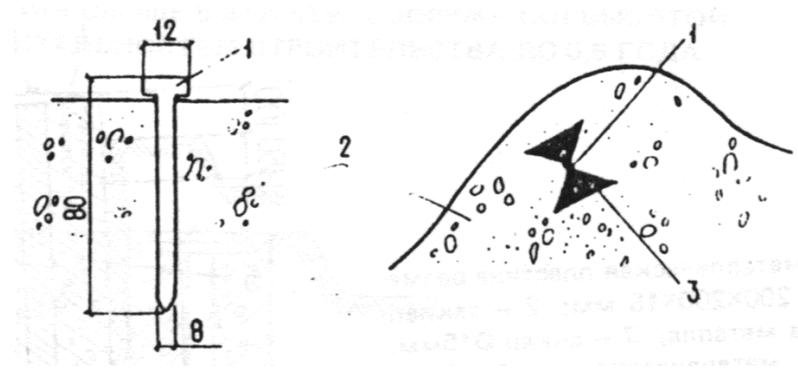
Закрепление разбивочных осей на скалах и бетоне: 1 – дюбель-гвоздь, 2 – скала, бетон, 3 – откраска [24]
